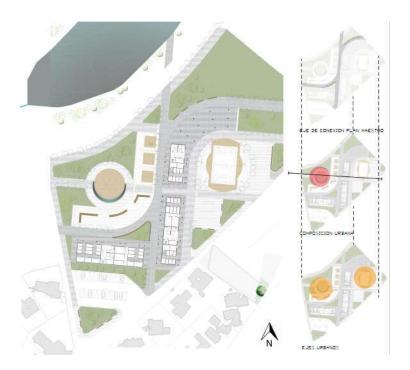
Diseño planta urbana. Fuente: © Elaboración propia 2020
